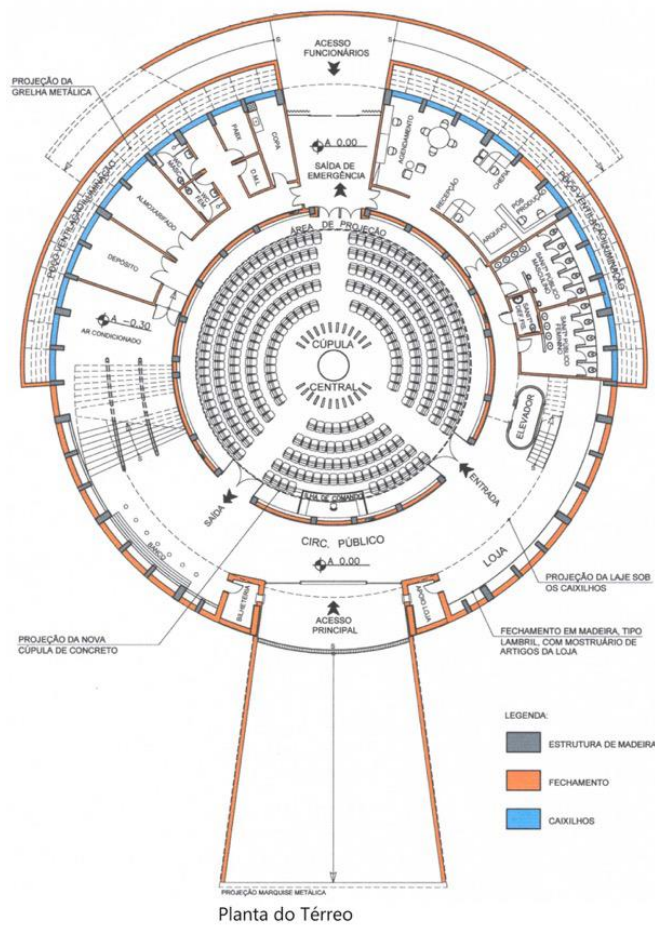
Planta Baixa do Planetário do Ibirapuera
